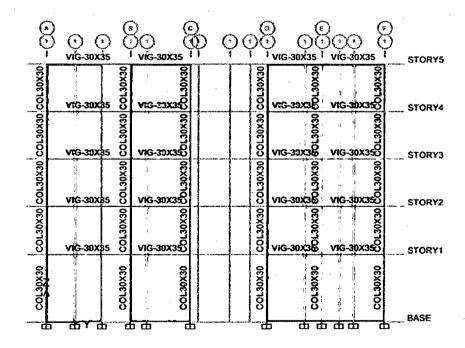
Secciones de Vigas y Columnas en Pórticos Secundarios.
